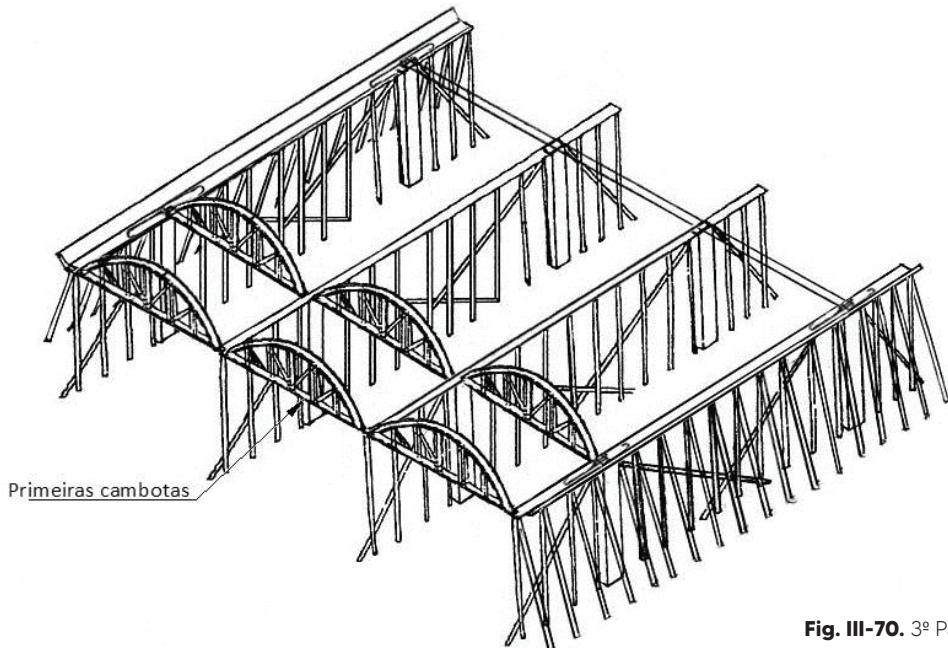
3º Passo. Colocação das primeiras cambotas. Avanço frontal. (*-5).
